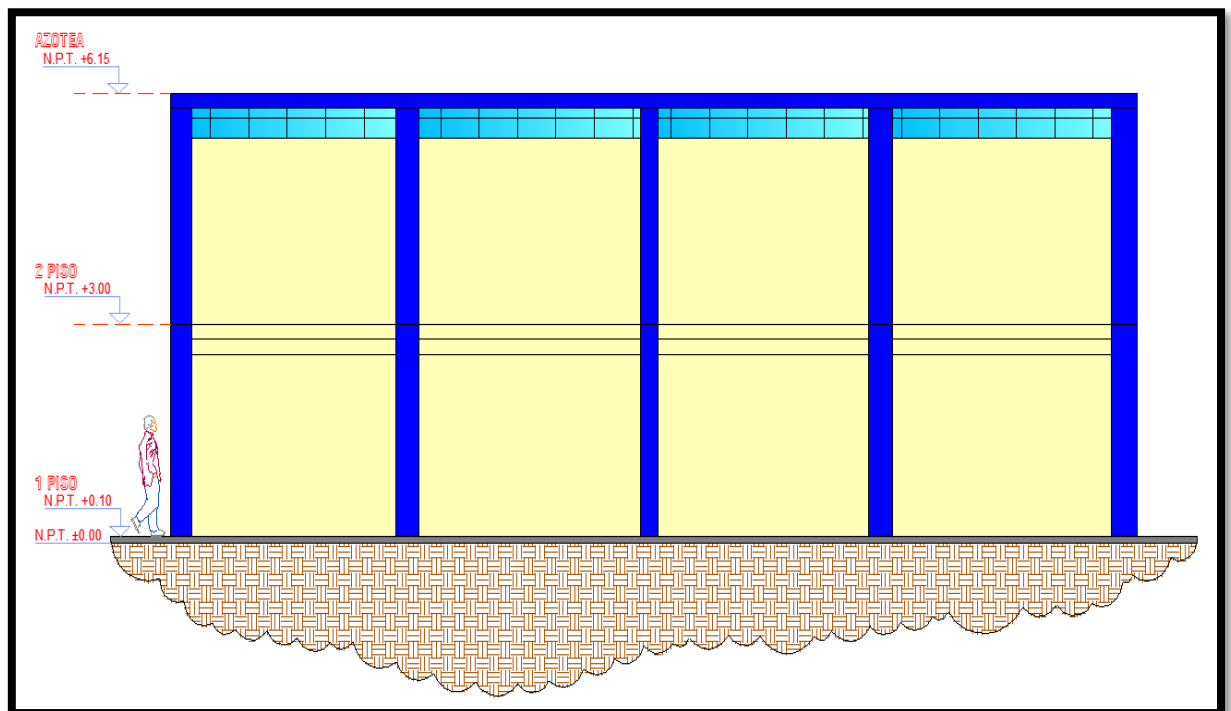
Plano de elevación corte eje: 4-4/A-E - vista frontal del pabellón "C"
